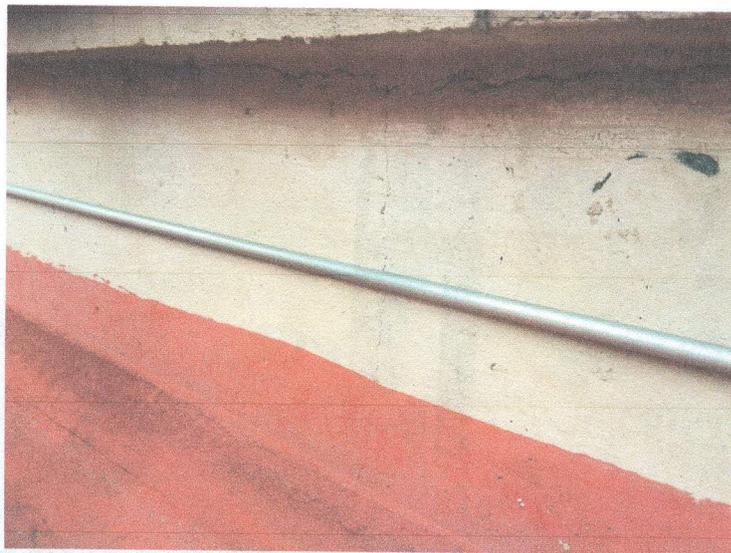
Revisión de pretil, grieta superficial en aplanado del muro si afectación a elemento base.
